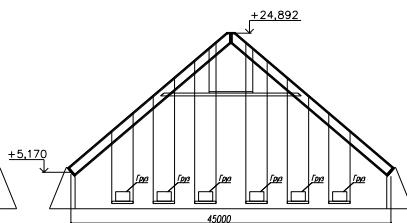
Схема испытания арок треугольного очертания нагружением бетонными блоками
